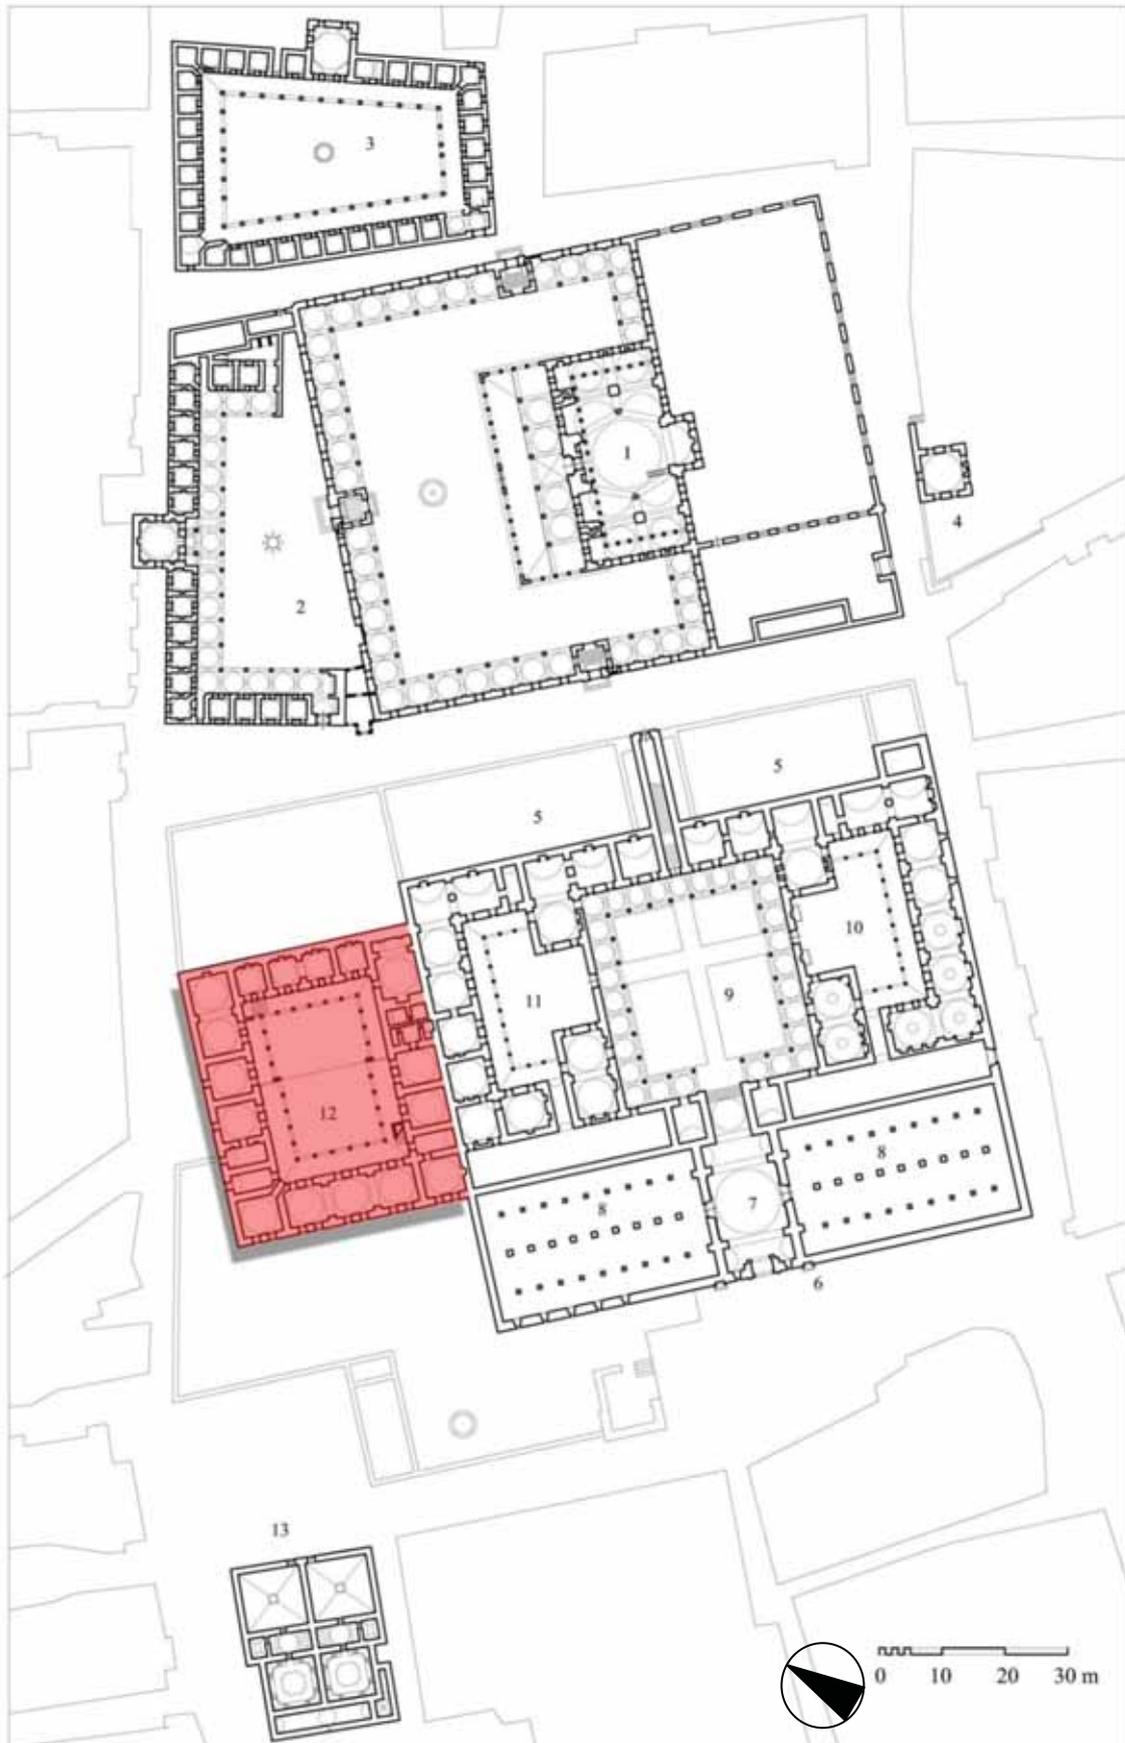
Grundriss und Lageplan des Krankenhauses
